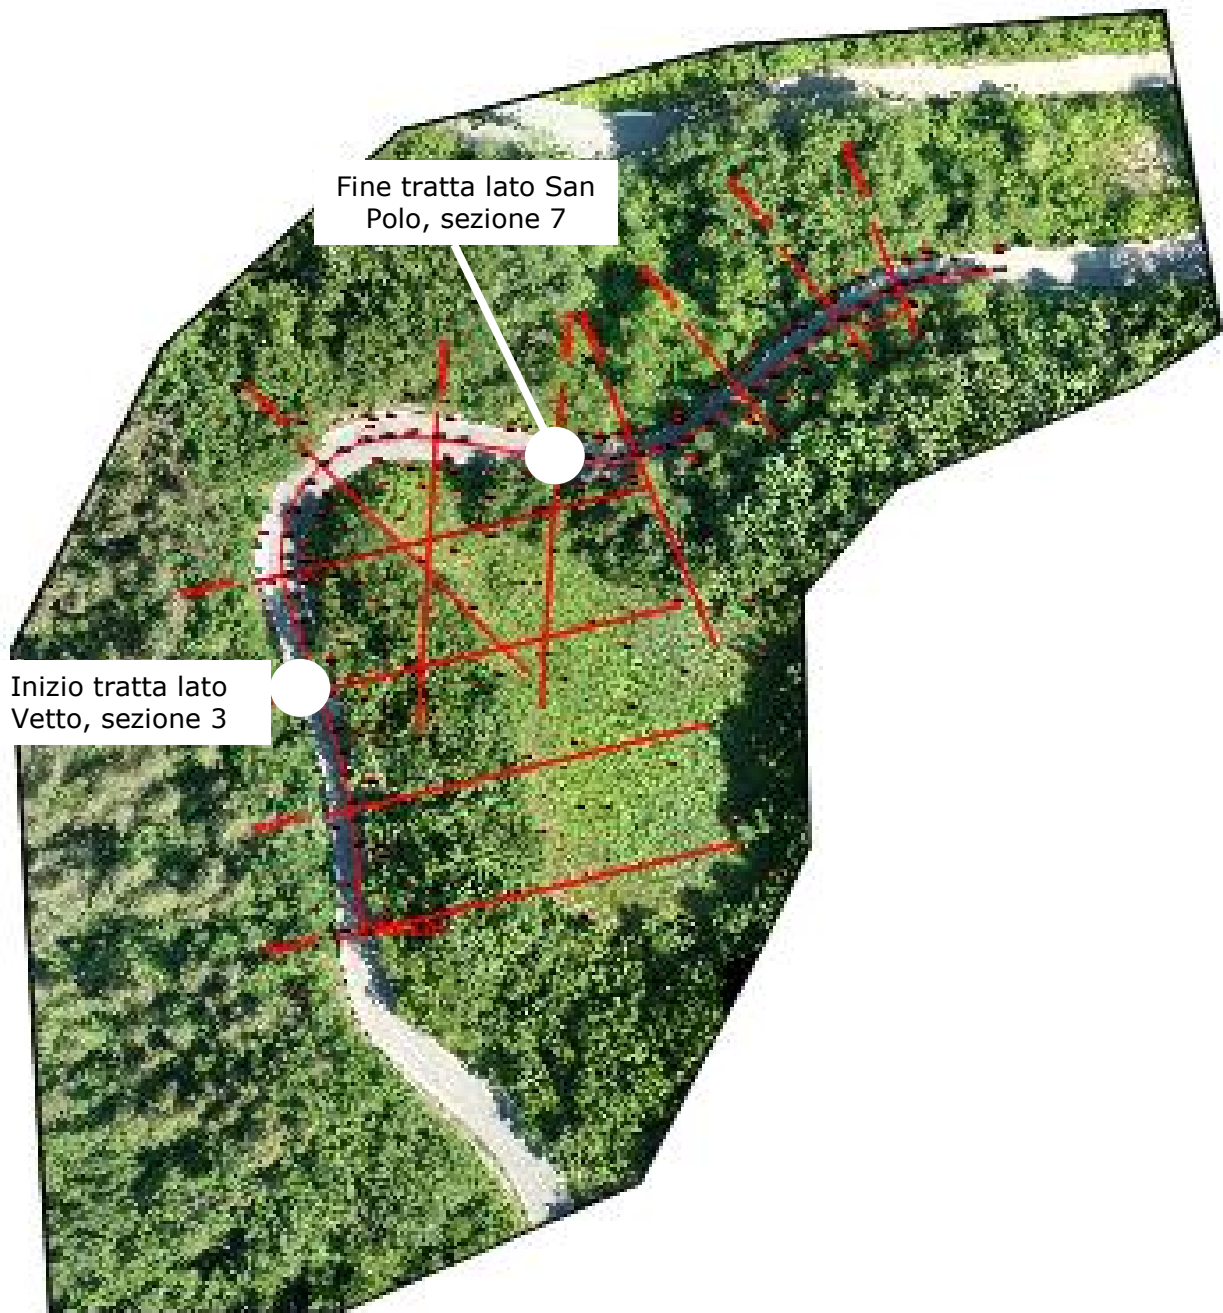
Ortofoto con tracce delle sezioni rilevate
